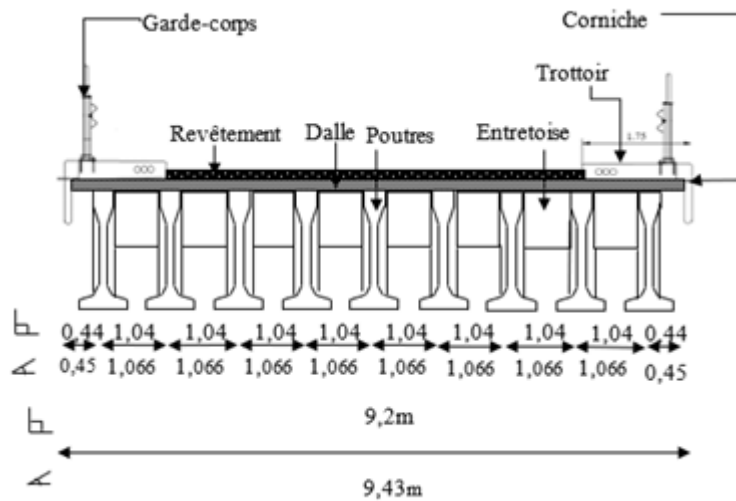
coupe transversale sur le tablier à poutres en BP.
